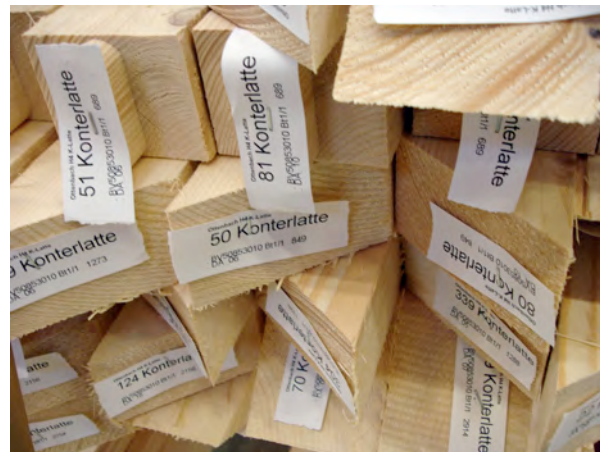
Eindeutige Bezeichnung der Bauelemente eines Dachstuhls mittels einer Etikettieranlage mit Heftmaschine, die als Zubehör der Abbundmaschine geliefert wird (Hector Egger, 2006; Foto: Autor)
